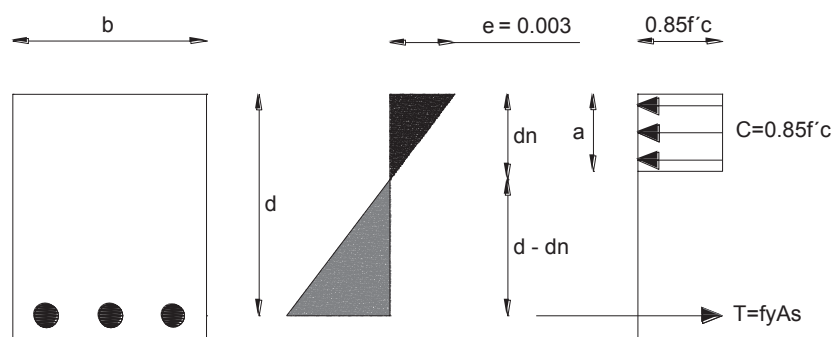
Sección rectangular solo con refuerzo de tensión
